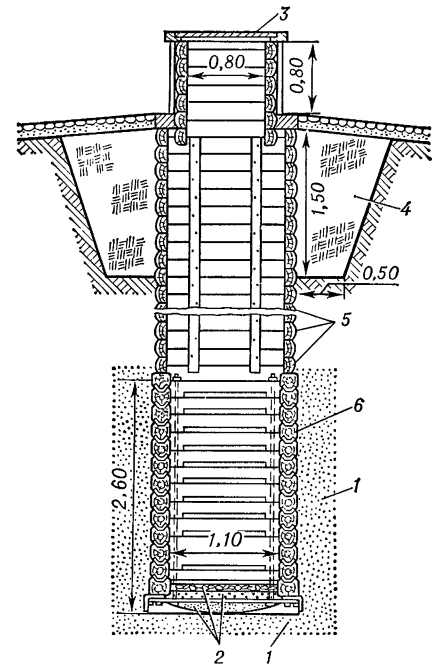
Схема шахтного деревянного колодца: 1 — песок; 2 — донный фильтр из песка, мелкого и крупного гравия и гальки; 3 — крышка; 4 — глиняный «замок»; 5 — бревенчатое крепление; 6 — венцы из бревен. Размеры указаны в метрах.
